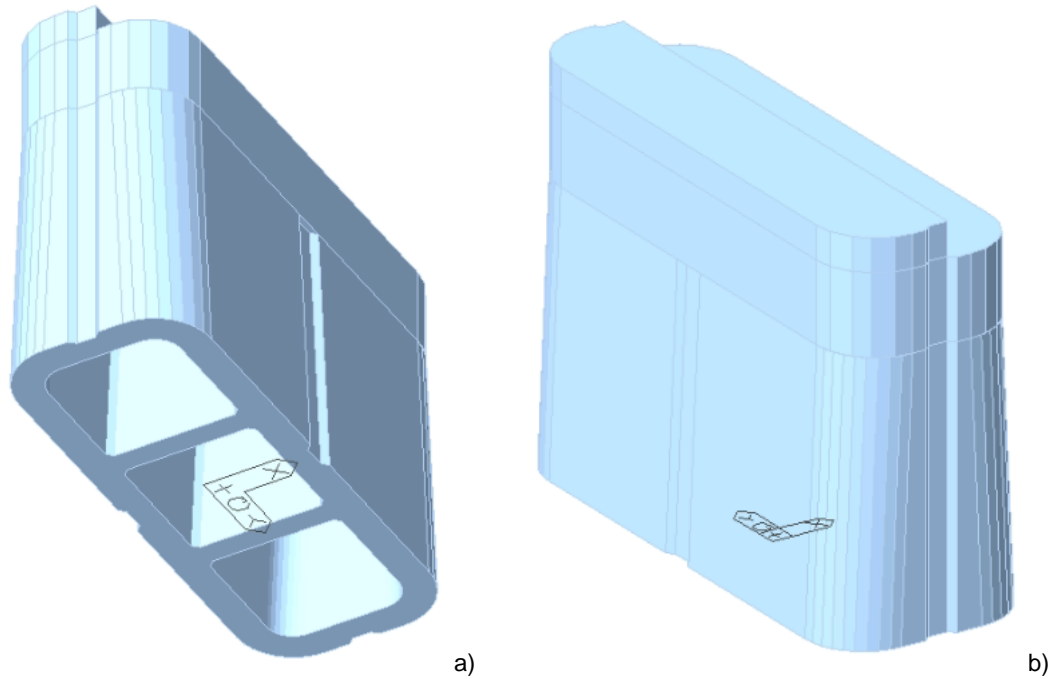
Modellazione tridimensionale agli Elementi Finiti – a) Vista 3D dal basso b) Vista 3D dall'alto – Pila P2
